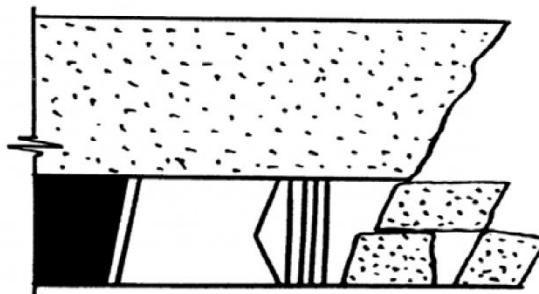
Первый тип разрушения кровли над подготовительной выработкой
